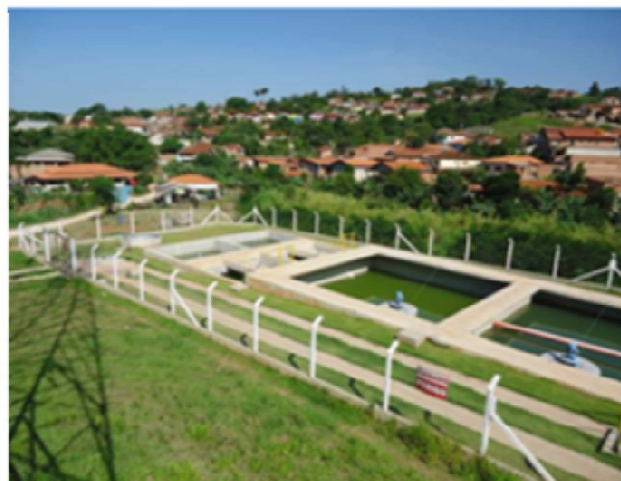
Vista da ETE do loteamento Terras de Monte Alegre
